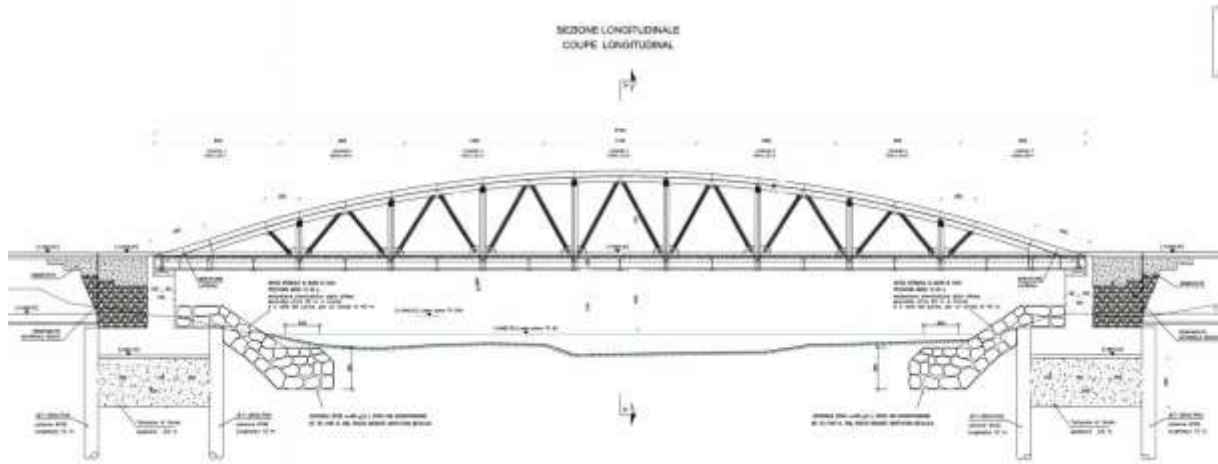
Prospetto ponte ad arco previsto dal progetto definitivo in variante.
